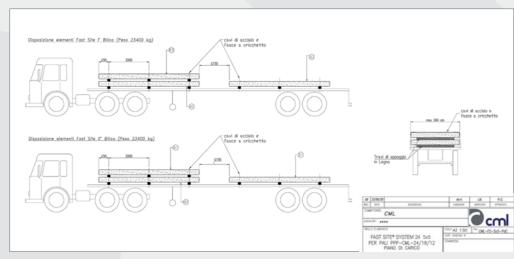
Piano di carico FAST SITE® SYSTEM 24
